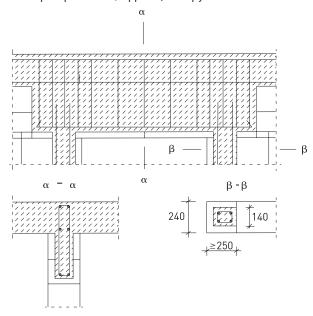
Бетонная перемычка с высокой несущей способностью, соединенная с венцом и опирающаяся на железобетонные столбики.
